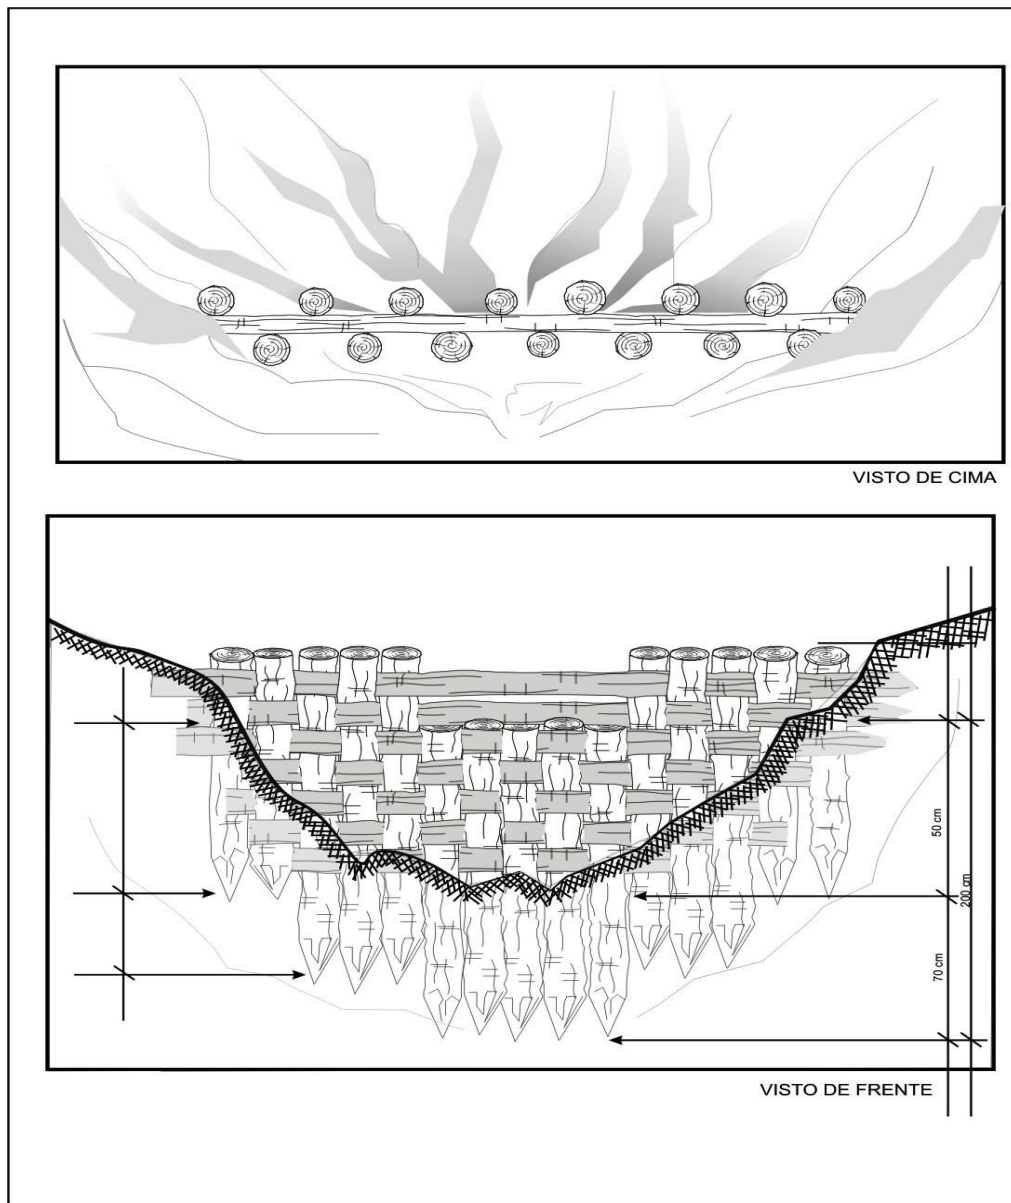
Proposta de construção de barragens para conter erosão dentro da voçoroca
